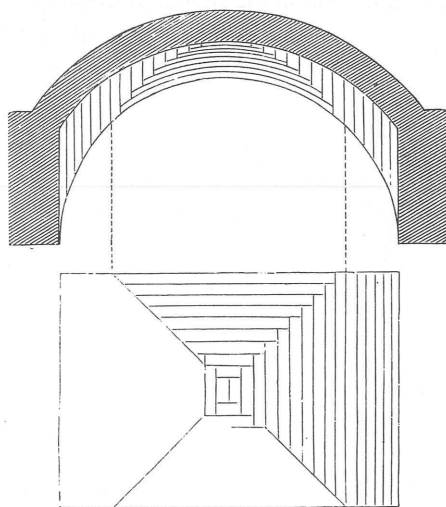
Bóveda esférica sobre planta rectangular construida por hojas
